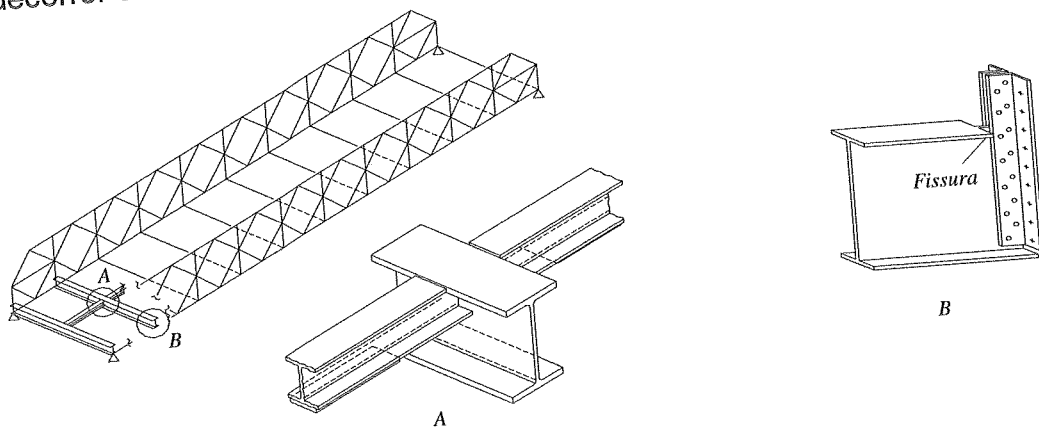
Sistema Estrutural da Ponte Dortmund-Ems e Localização da Fissura.
